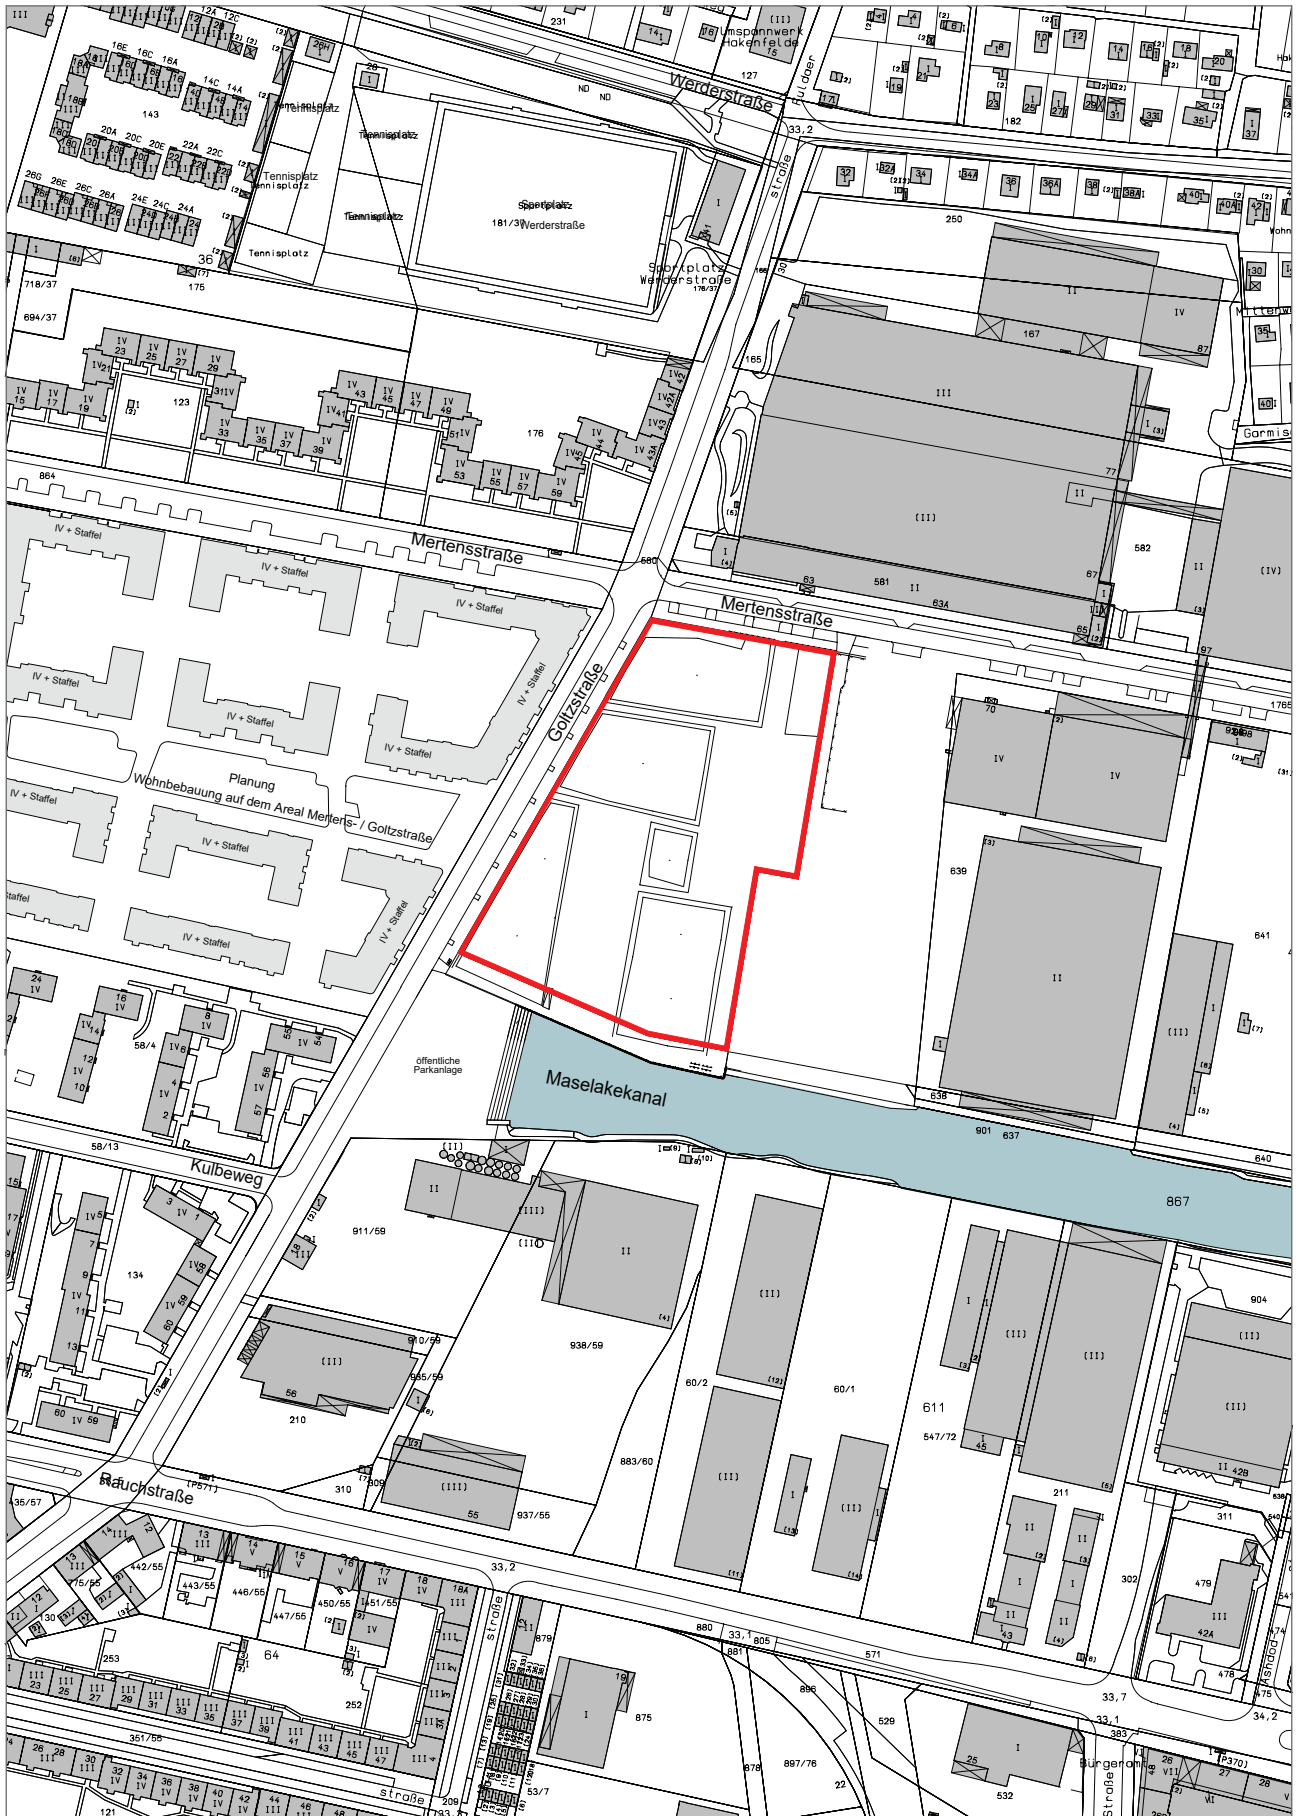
Lageplan mit Markierung des Wettbewerbsbereichs
